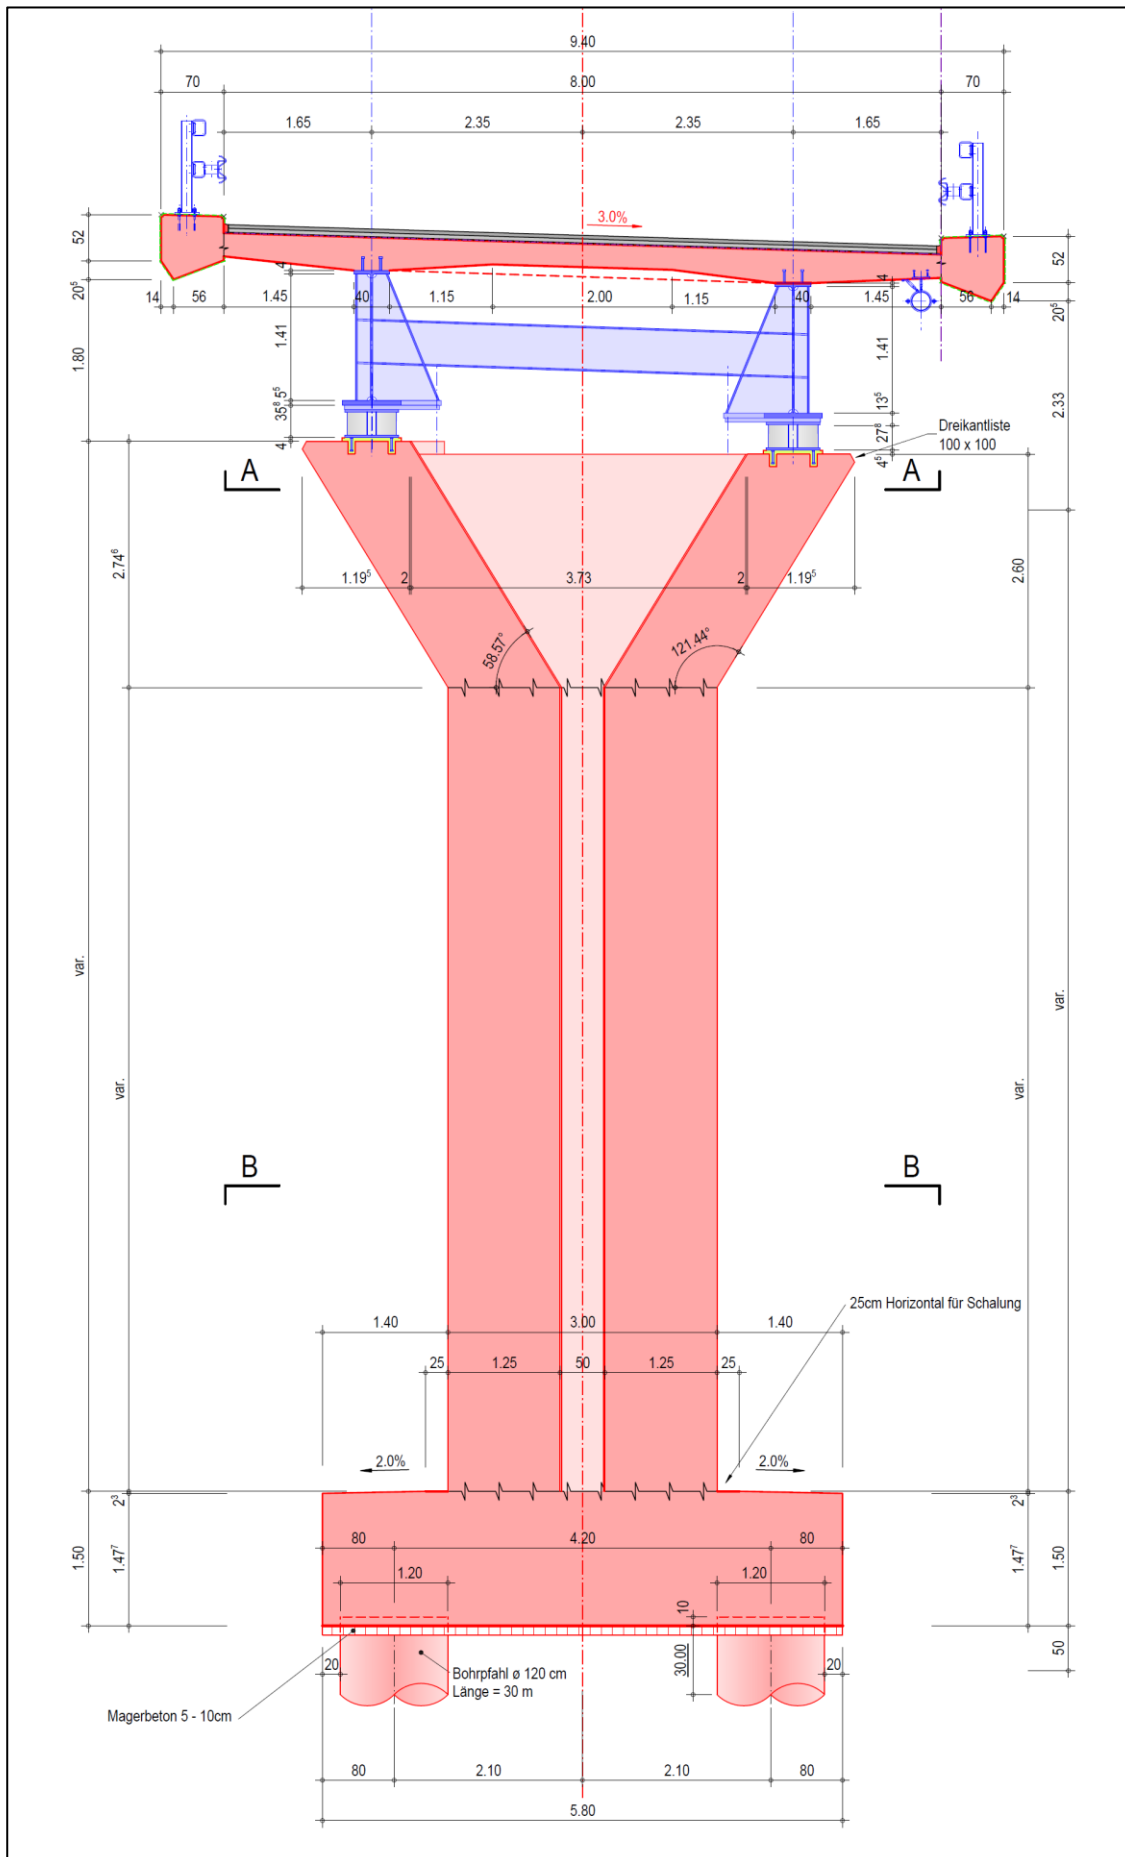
Querschnitt neuen Brückenpfeiler R1 – R11 mit Pfahlfundation
